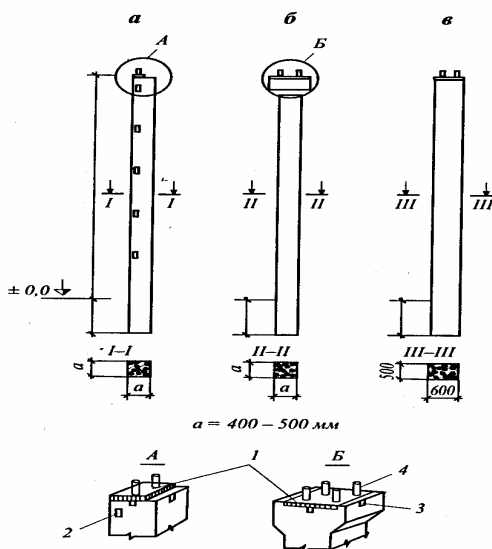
Сборные железобетонные колонны для бескрановых пролетов одноэтажных зданий:
